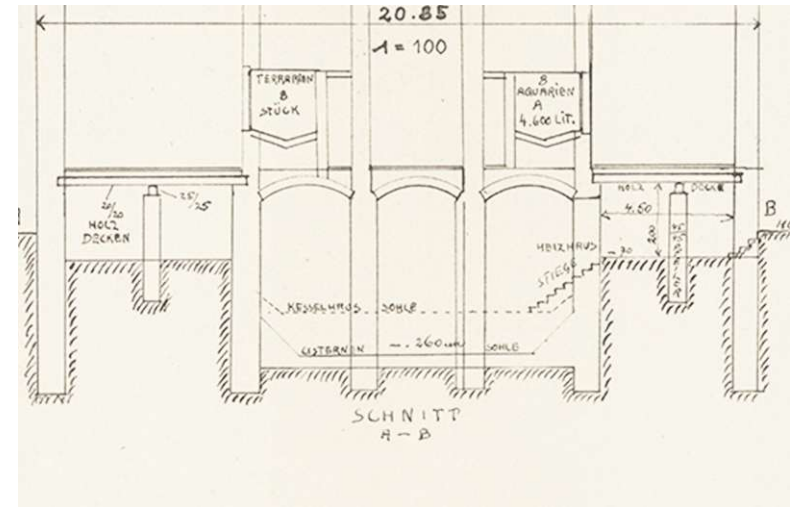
Planausschnitt Kellergeschoss 1944 | BVA:
